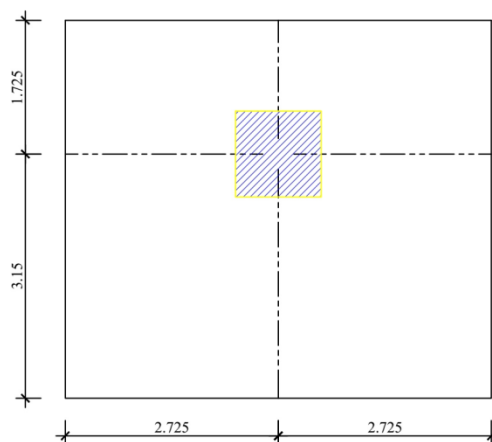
La section la plus sollicitée du poteau rectangulaire.
